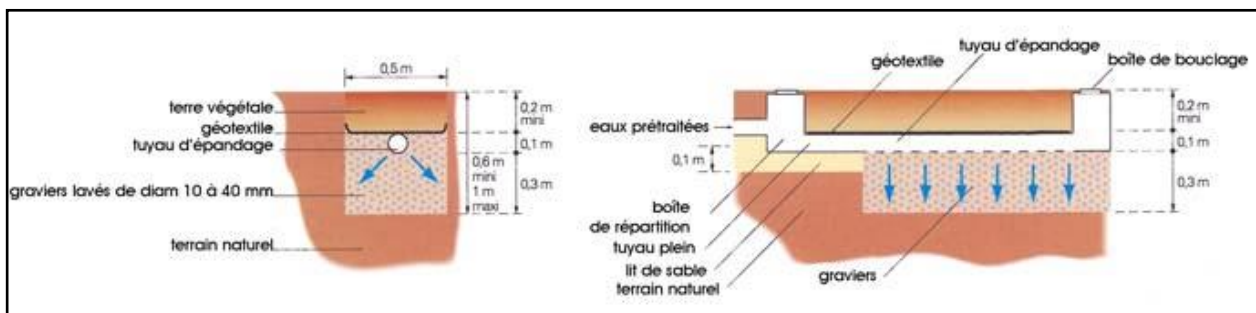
Schéma d'une tranchée d'infiltration (*landru.fr*)
